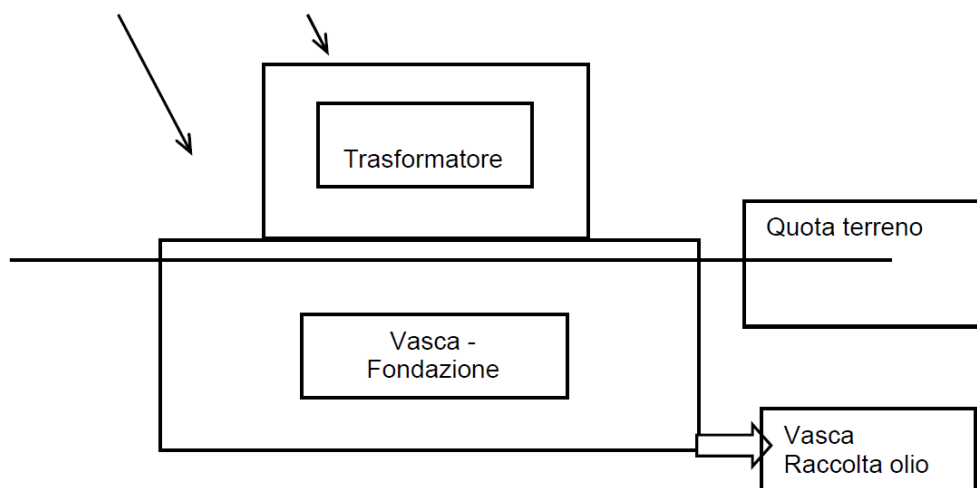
SCHEMA DELLA FUNZIONE VASCA FONDAZIONE
